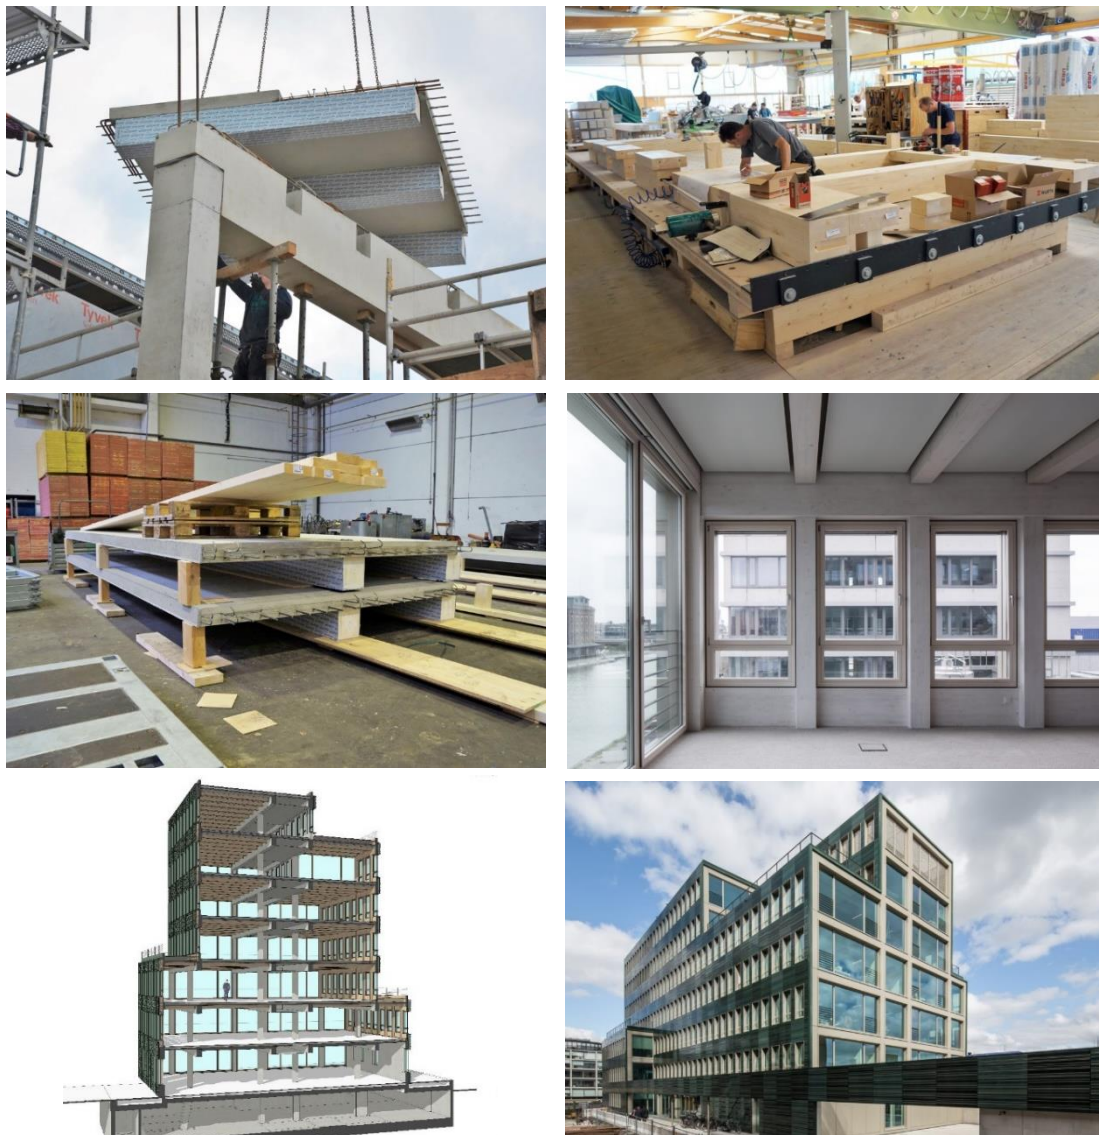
Fertigbauteile in Holz-Beton Hybridbau, Tragstruktur, Fertigstellung [84][85]
